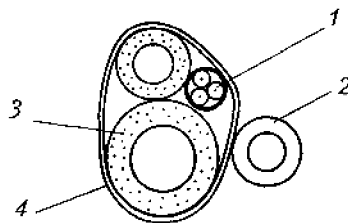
Теплоизоляция фреоновых трубопроводов:
